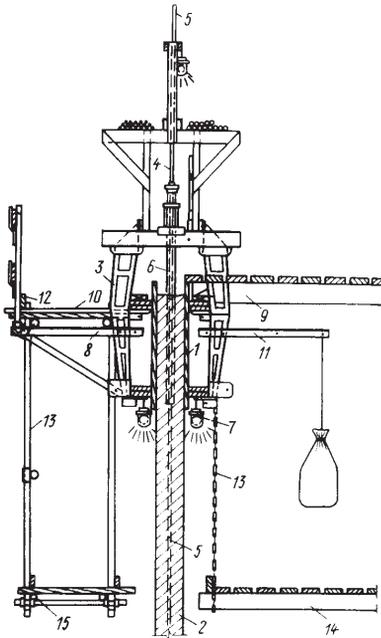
Схема крепления уравнивающей консоли (1 — щит опалубки; 2 — железобетонная стена; 3 — домкратная рама; 4 — гидродомкрат; 5 — домкратный стержень; 6 — защитная трубка; 7 — осветительное оборудование; 8 — консоль для опирания верхней наружной рабочей площадки; 9 — верхняя внутренняя рабочая площадка; 10 — верхняя наружная рабочая площадка; 11 — уравнивающая консоль; 12 — перила ограждения; 13 — вертикальные тяги крепления нижней рабочей площадки; 14 — нижняя внутренняя рабочая площадка; 15 — нижняя наружная рабочая площадка)
